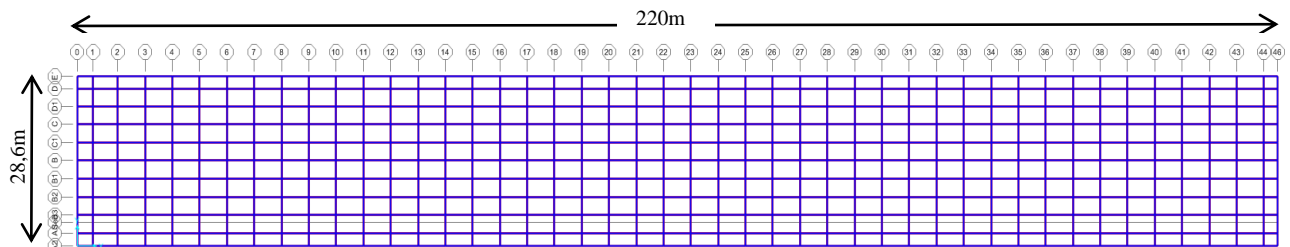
Vista en planta de geometría, paralelo a plano X-Y.
